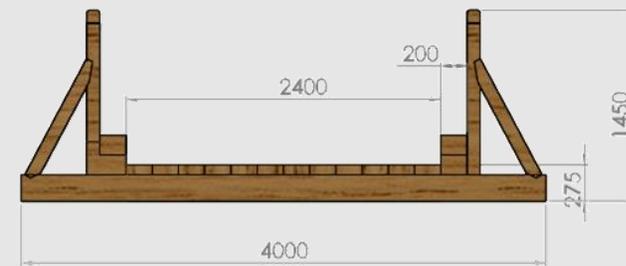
Vista transversal tablero para pasarela peatonal sobre vigas metálicas- ancho de calzada 2,4 m.
